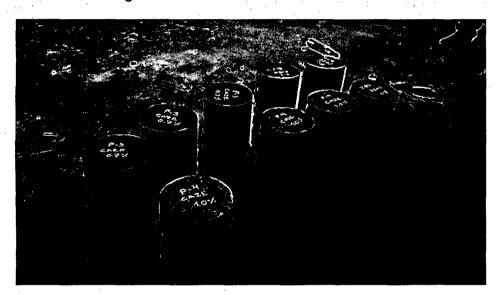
Probetas de concreto debidamente rotuladas.
